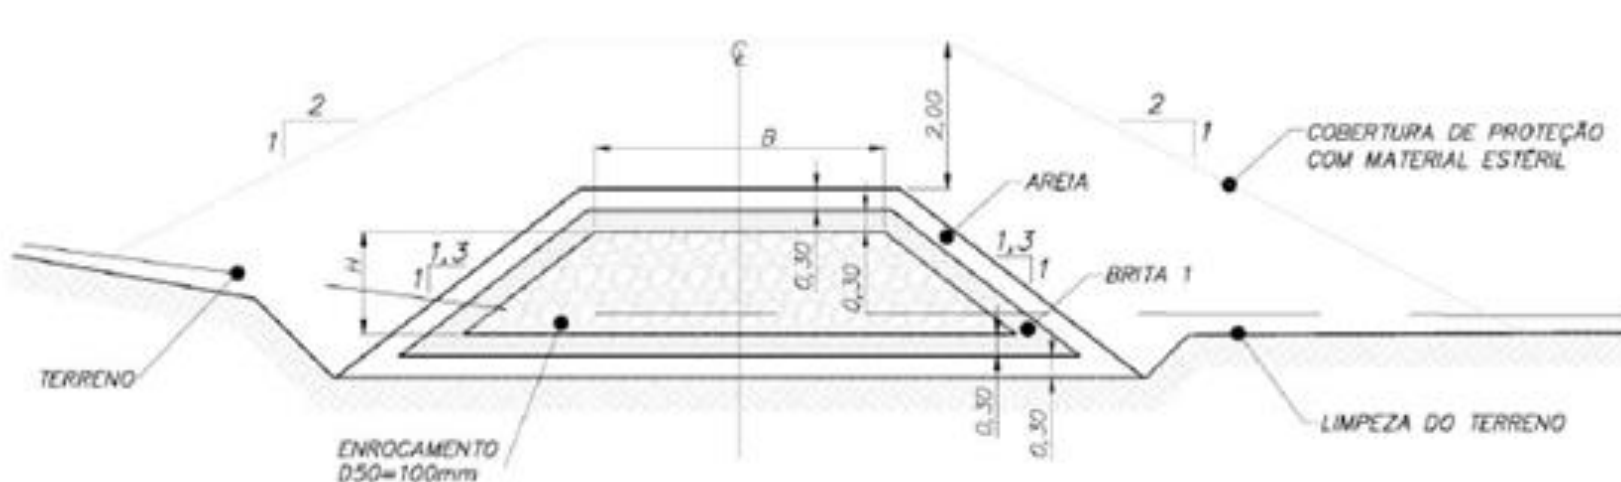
Croquis da seção transversal típica dos drenos de fundo.
